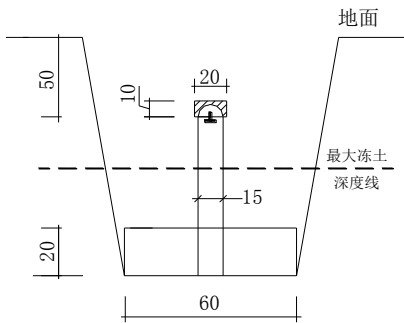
钢筋混凝土柱普通水准标石
